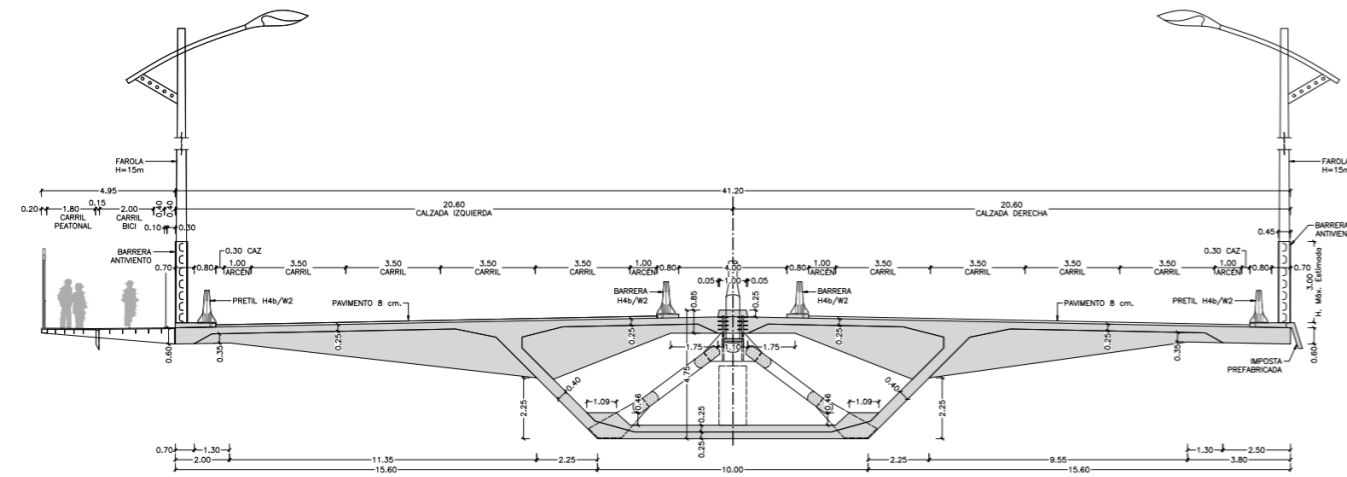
Tramo atirantado. Sección tipo de tablero por anclaje de tirante
